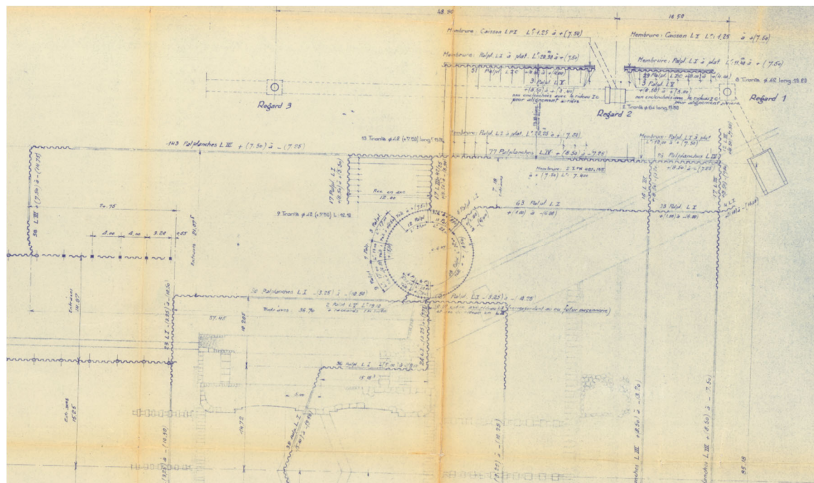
Plan de battage des rideaux de palplanches (plan 71B archives DREAL)
